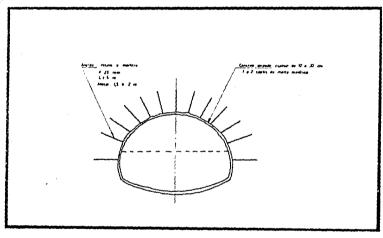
ANCLAS Y CONCRETO LANZADO.
